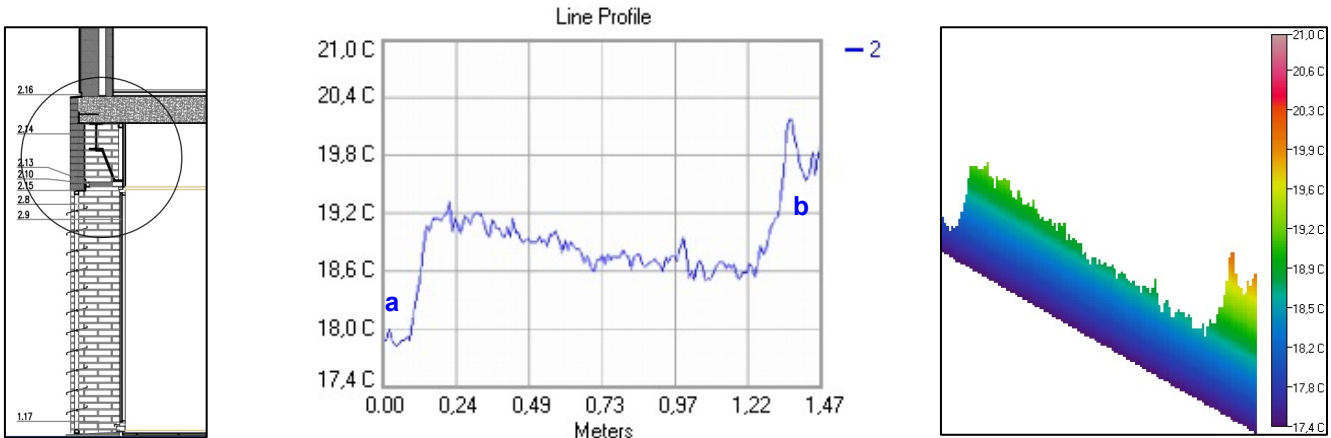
Detall secció façana planta baixa i planta primera (Font: Memòria Constructiva Edifici) . Gràfic línia 2 i perfil del comportament tèrmic línia 2 (Font: Elaboració pròpia amb software Image Processor Pro II)
